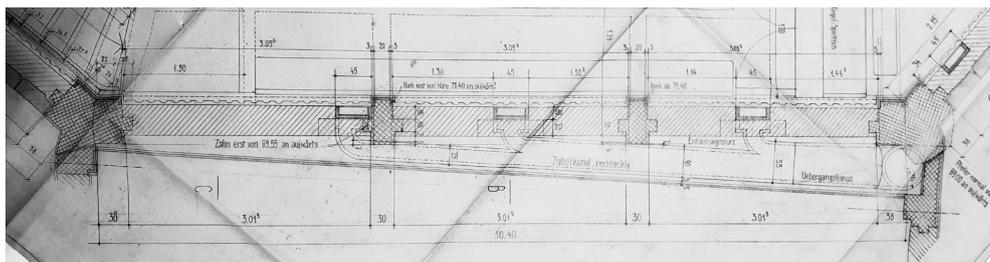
Grundriss Auf der Empore - die Lüftungseinlässe sind gut erkennbar
